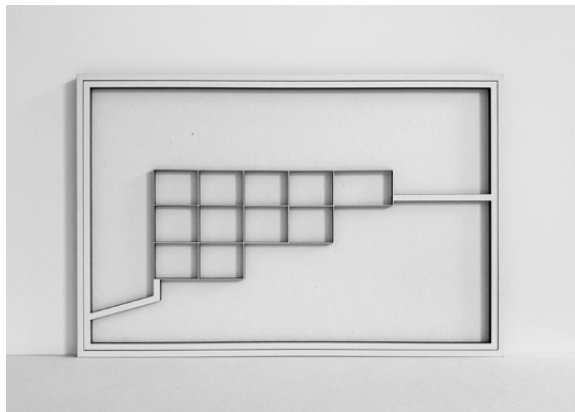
Modellfoto Struktur, Smith House, Ellwood
